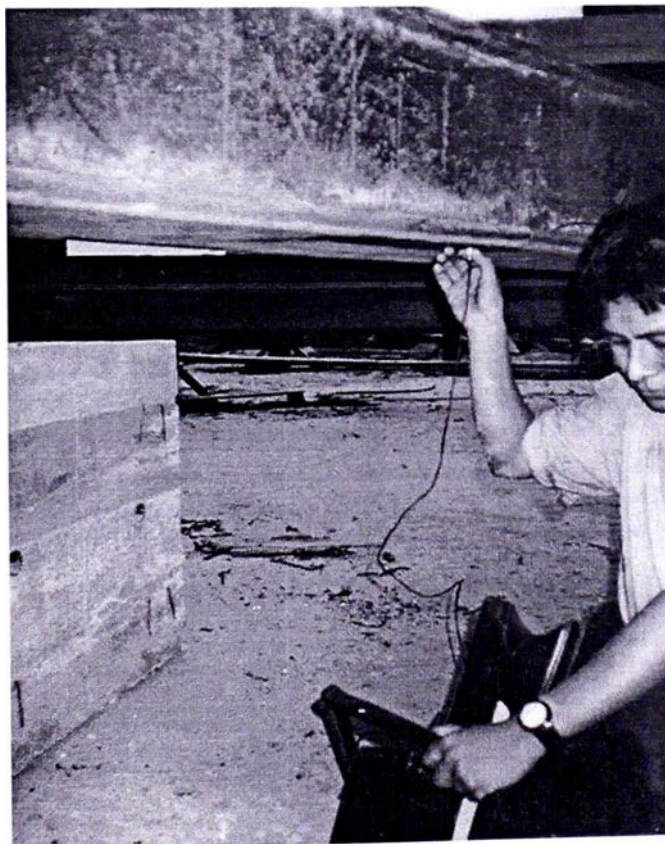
Prueba de Ultrasonido en Junta Soldada en Esquina
